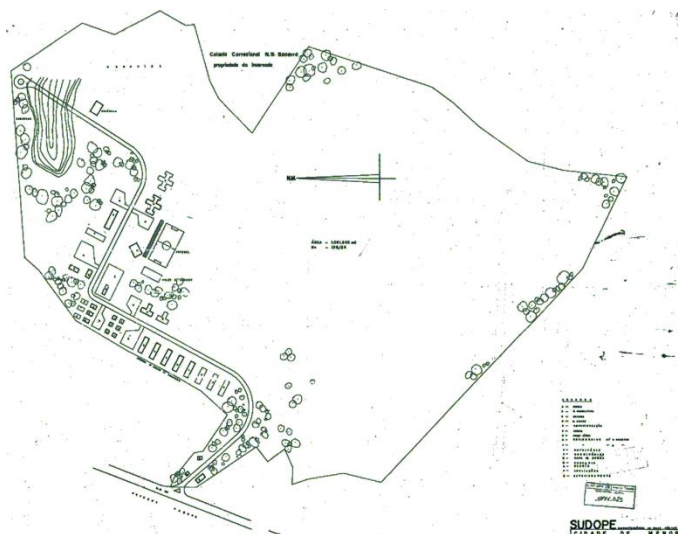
Planta Baixa da Cidade de Menores¹⁰⁰⁷
